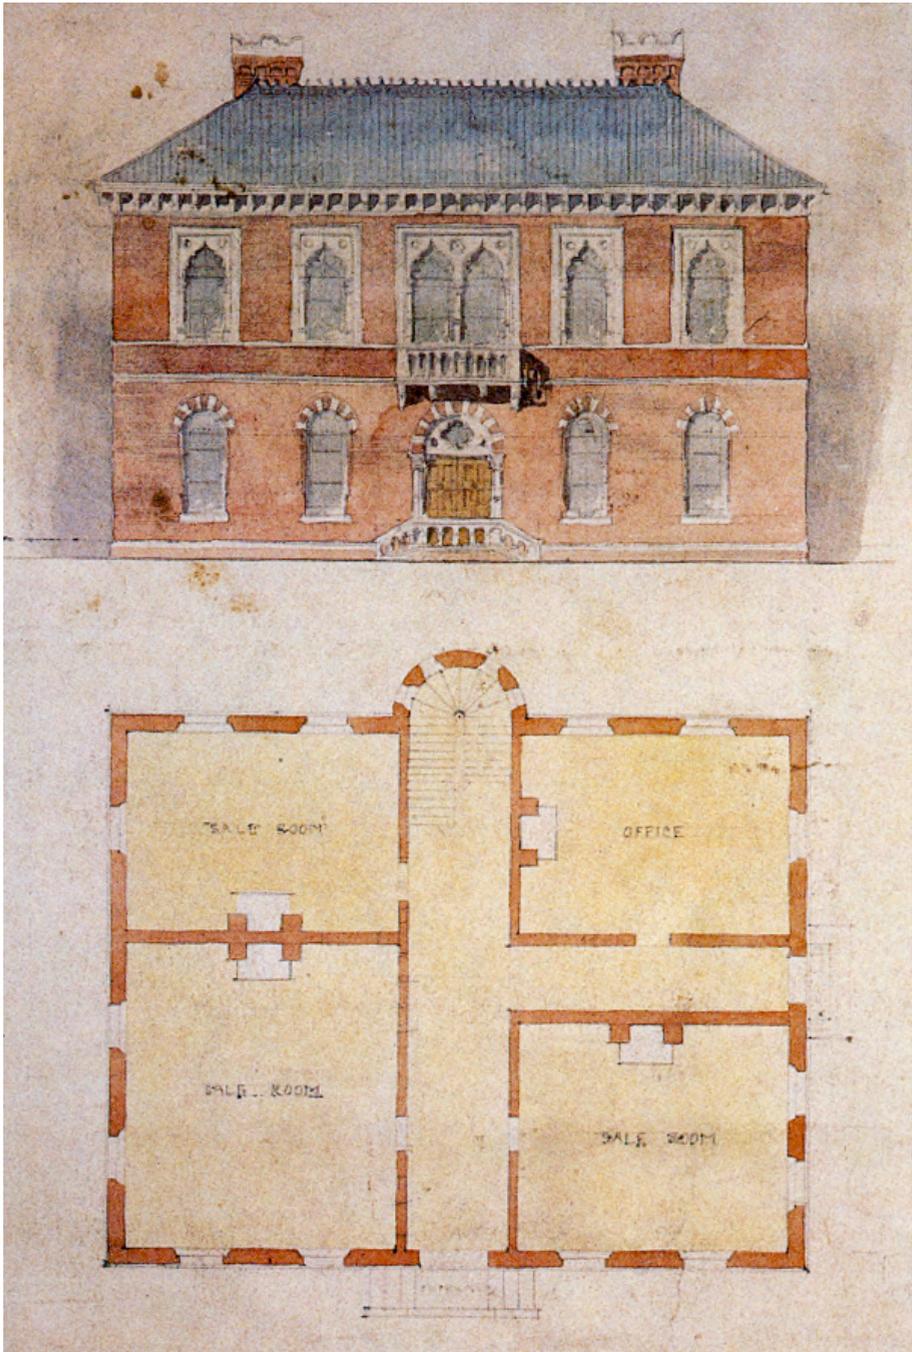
Progetto di Hokkaidō kaitakushi, facciata e pianta del pianterreno, Tatsuno Kingo, 1878
